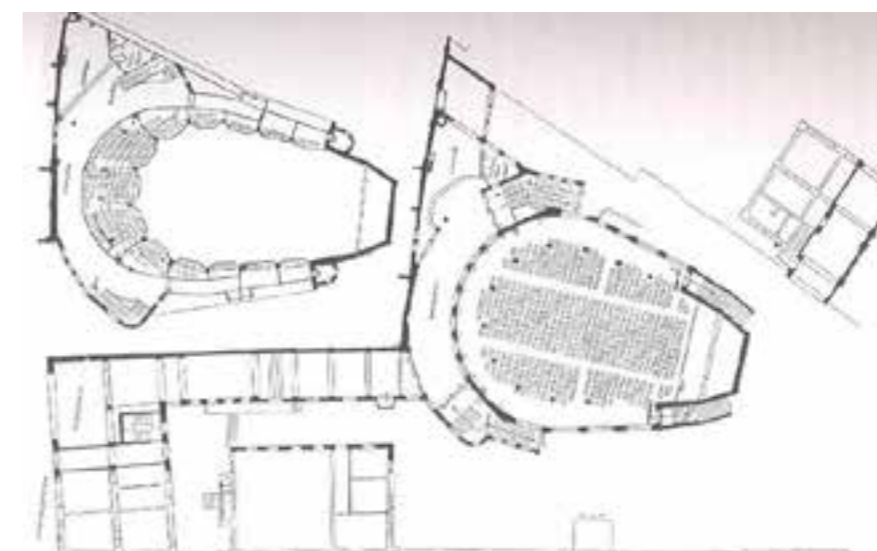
pianta galleria e platea Martin Pietzsch Union di Dresda
